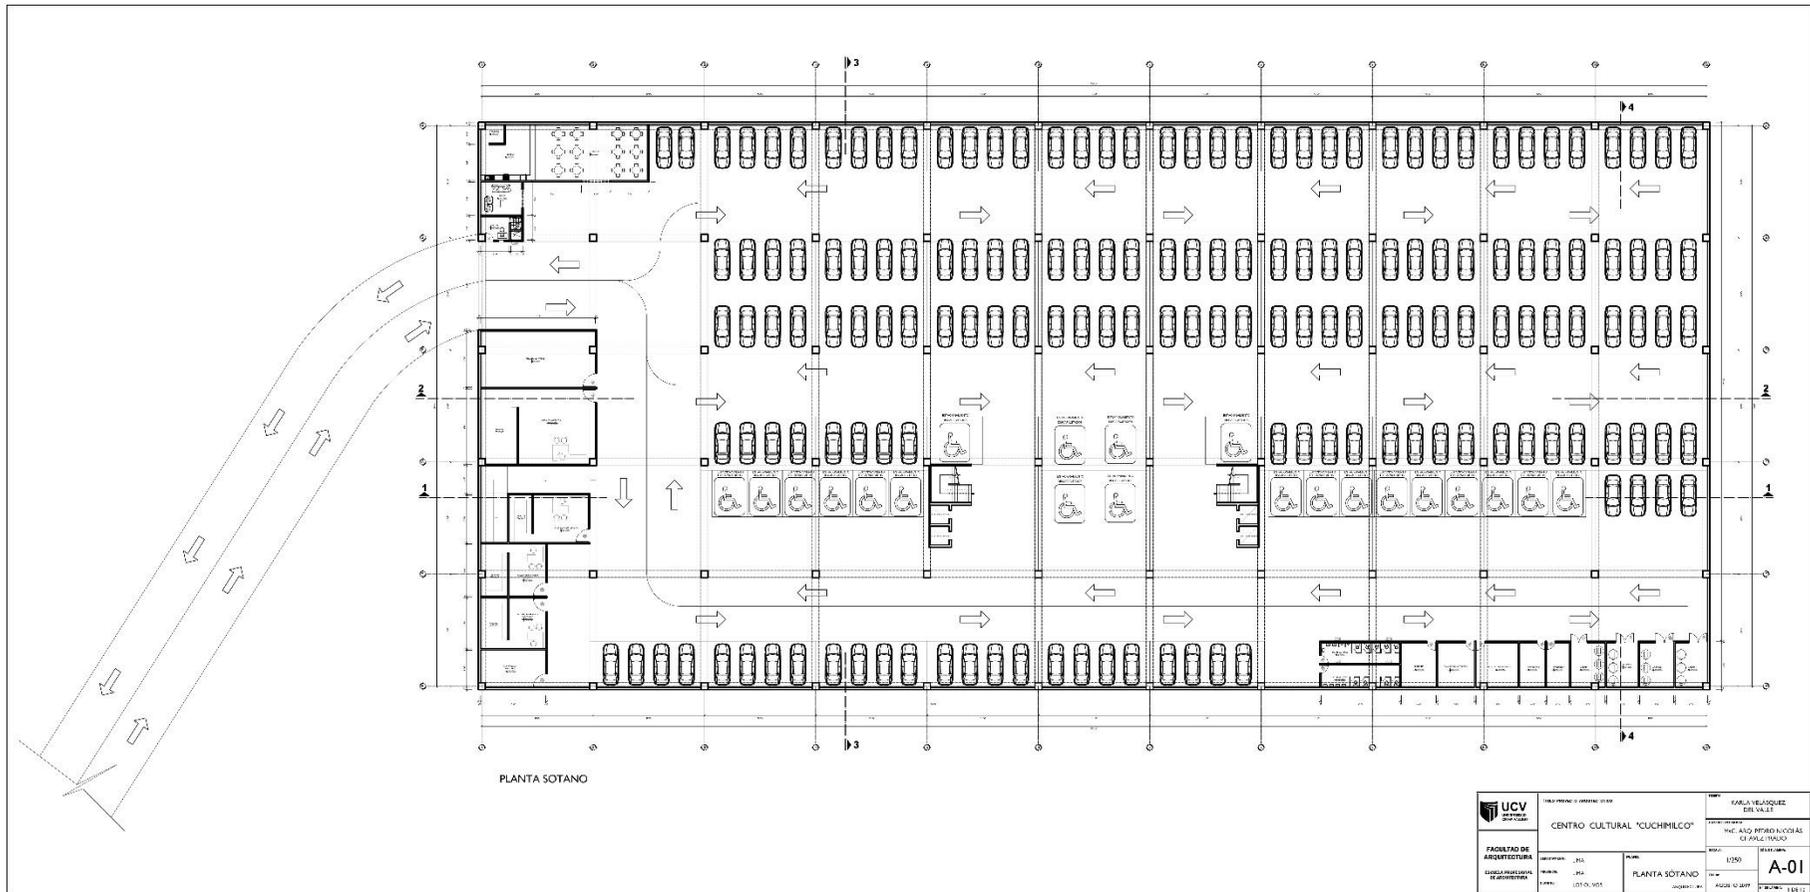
Plano de Arquitectura Planta Sótano. Elaboración propia
